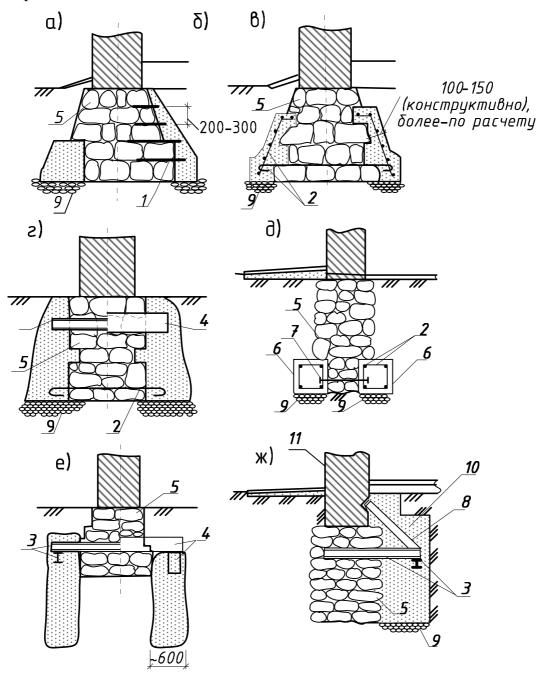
Конструкции усиления бутовых и бутобетонных фундаментов: а - замена камней в нижних рядах; б - устройство бетонной рубашки; в - железобетонная обойма; г — двусторонний банкет с передачей части нагрузки с помощью поперечных балок; д - железобетонные приливы (продольные балки) в нижней части фундамента; е - передача нагрузки за пределы подошвы фундамента на бетонные массивы; ж - односторонний банкет для увеличения опорной площади; 1 - металлические стержни d=18-24 мм; 2 - арматура d=16-20 мм; 3 - металлические балки; 4 - железобетонные перемычки или балки; 5 - фундамент; 6 - монолитные железобетонные приливы (продольные балки); 7 - затяжка стальная; 8 - подкос; 9 - уплотненный грунт; 10 - бетонный банкет; 11 - упорный уголок.
